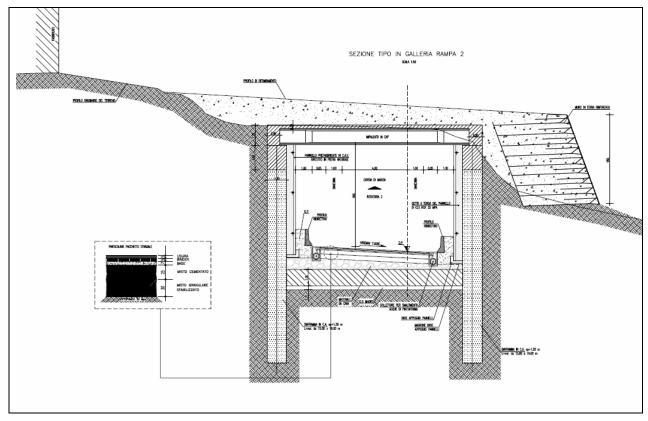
Sezione trasversale tipo galleria artificiale RAMPA2
